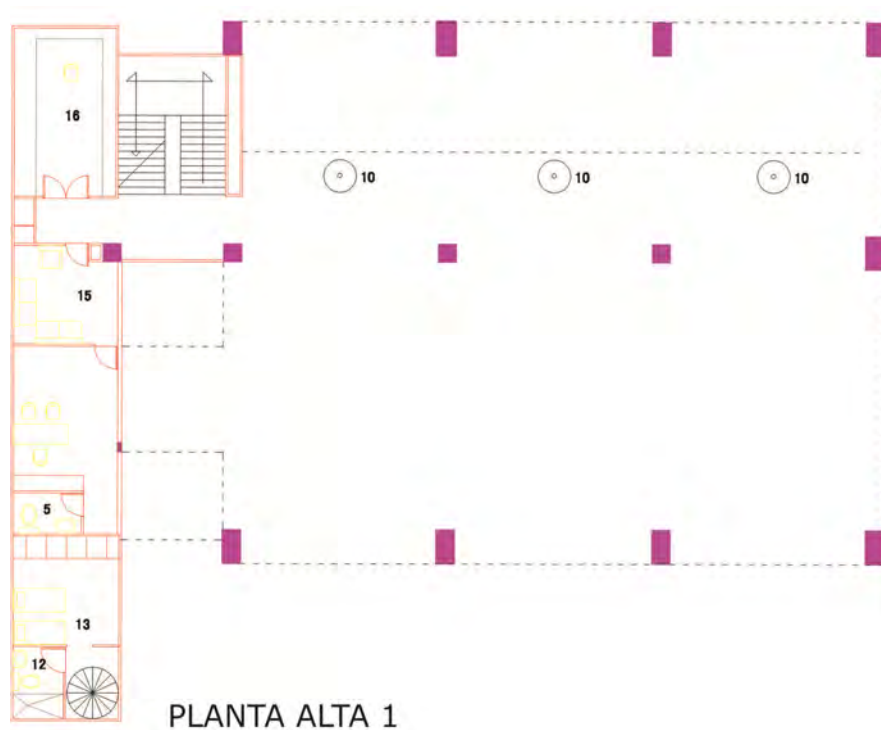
PLANTA PRIMER PISO ARQUITECTONICA, CENTRAL DE BOMBEROS IZTAPALAPA.
